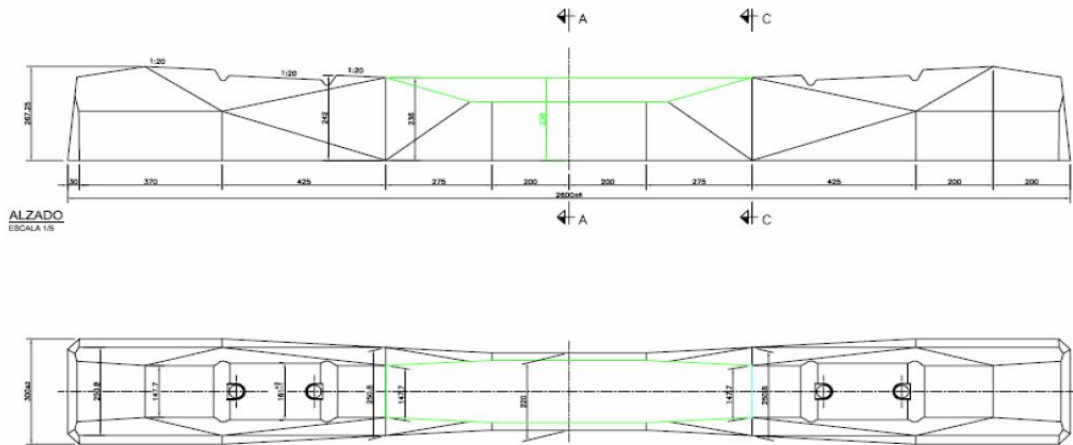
PLANTA Y ALZADO DE AEROTRAVIESA
